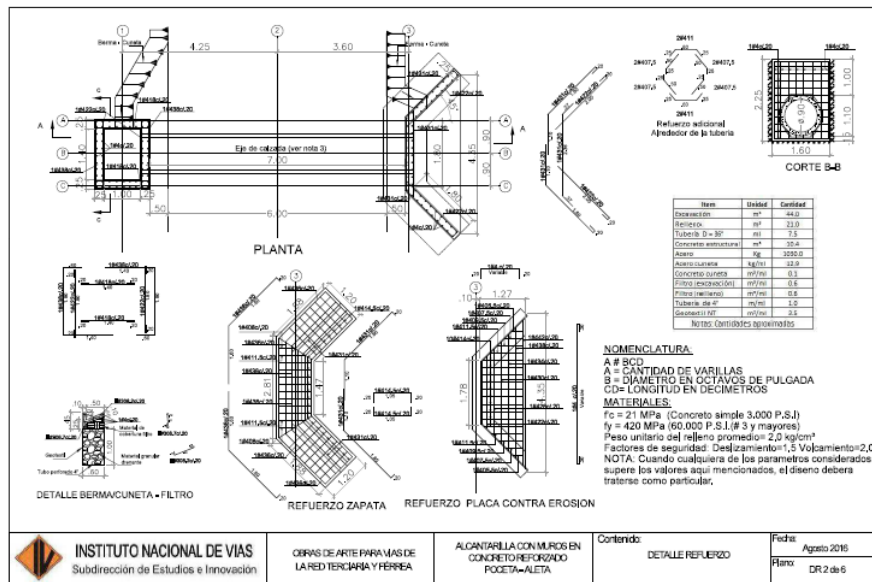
Detalle del refuerzo de alcantarilla parte 2.
